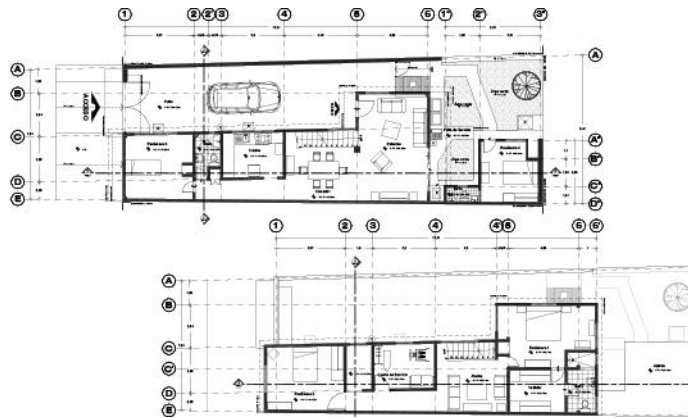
Plantas arquitectónicas derivadas del levantamiento de una vivienda existente.
